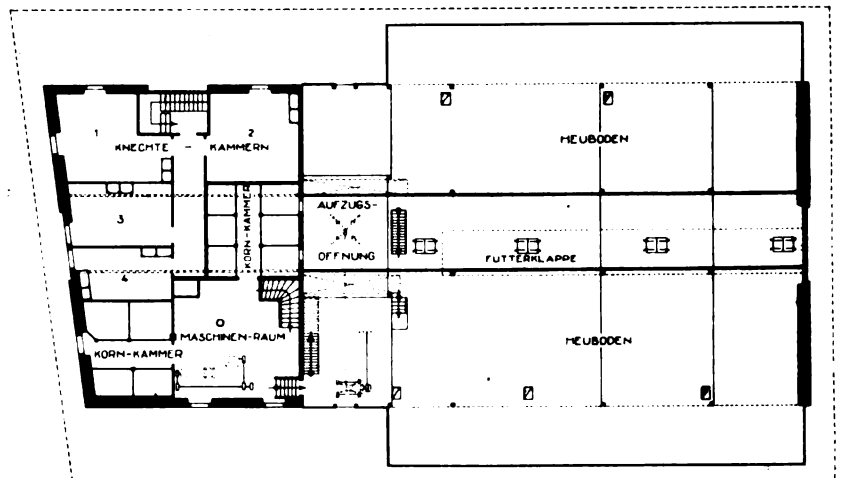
bis 5. Grundrisse und Längsschnitt. — Masstab 1:400.
